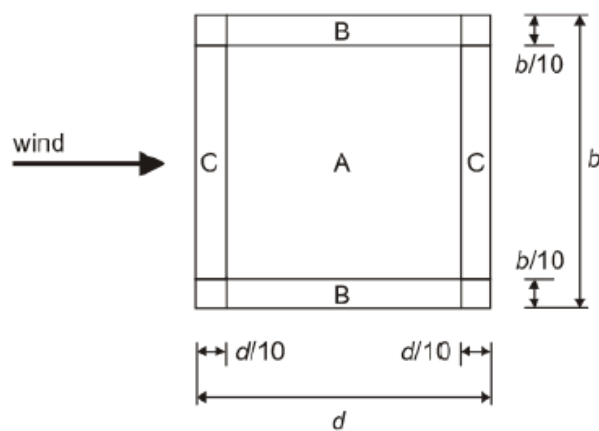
Divisão da área da cobertura em planta (adaptado de EN 1991-1-4, 2010)
